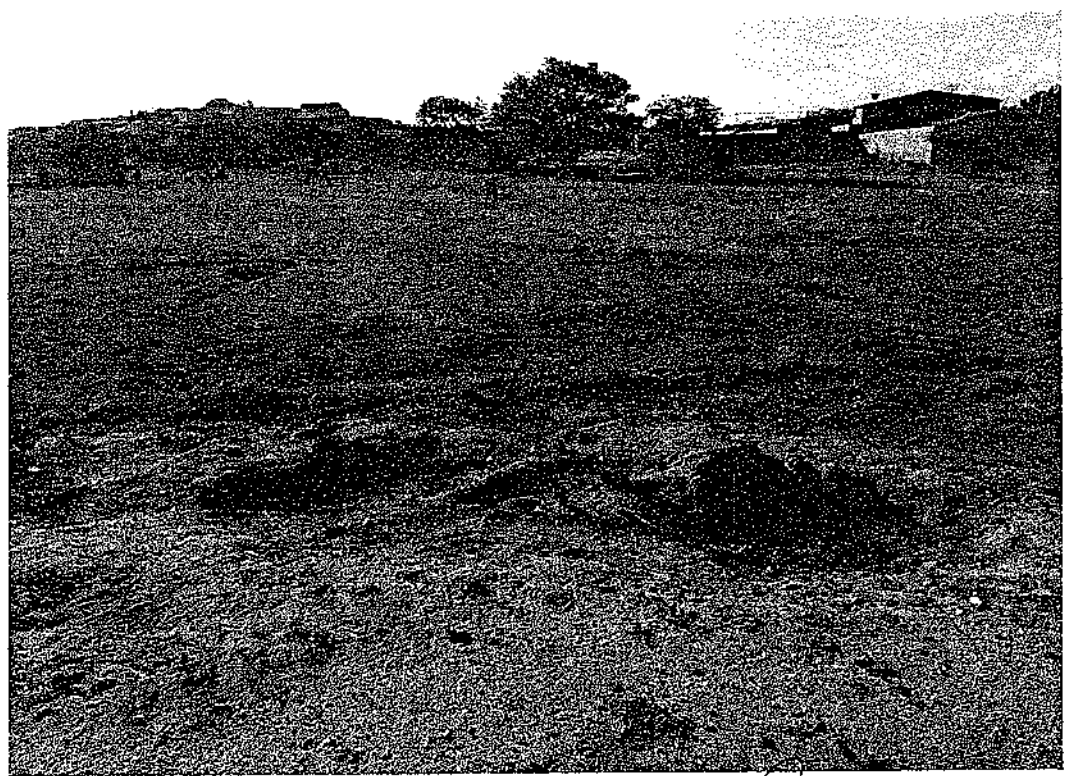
Rua projetada 02 Bairro Jose Pessoa Filho. Coordenadas 541820 / 9346919
